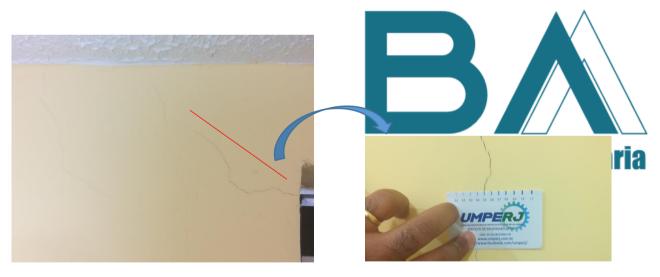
Fissuras canto de janela (VISTA E)
